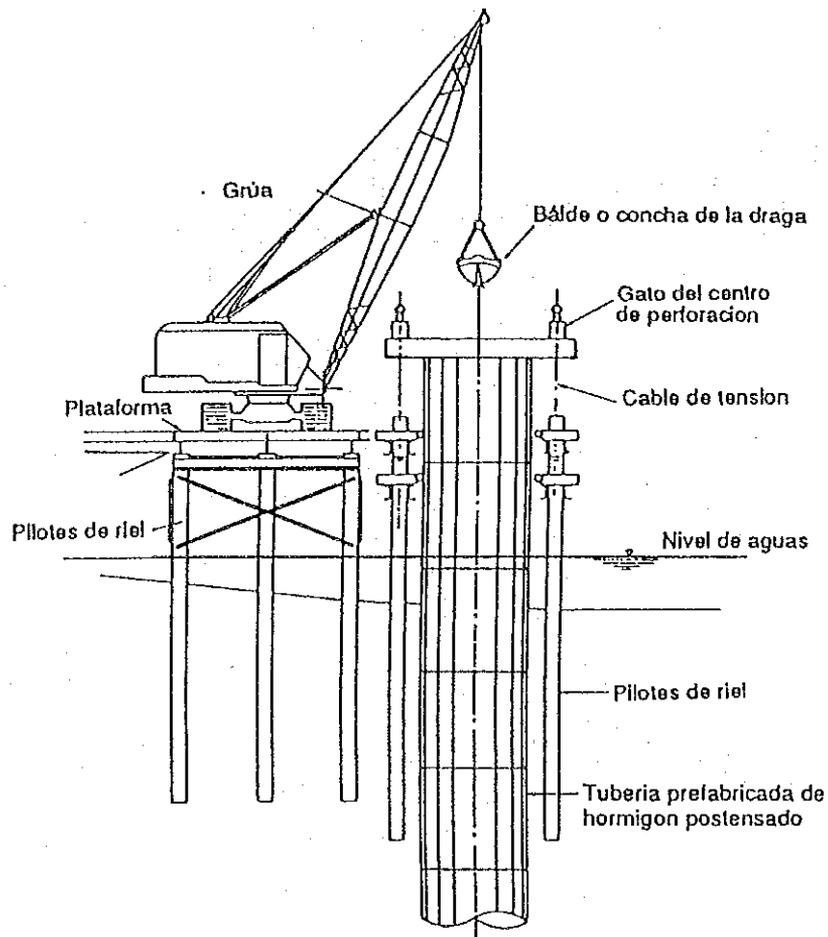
Método de construcción de las fundaciones tipo cajón
